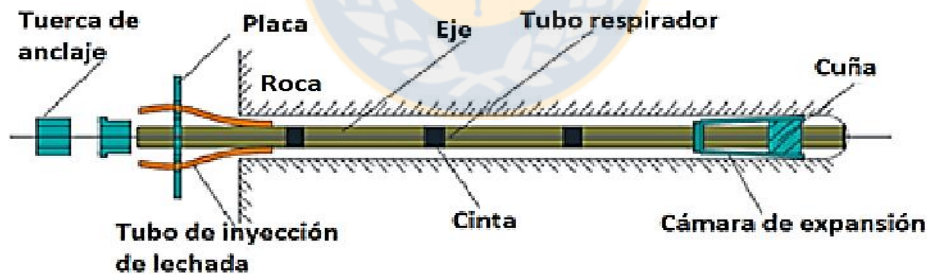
Componentes de un perno de anclaje mecánico con cabeza de expansión.
